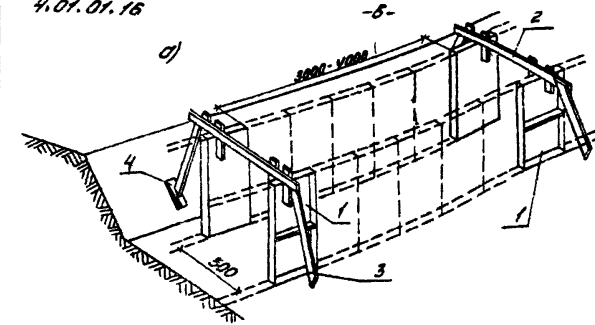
Схема монтажа опалубки ленточных фундаментов
